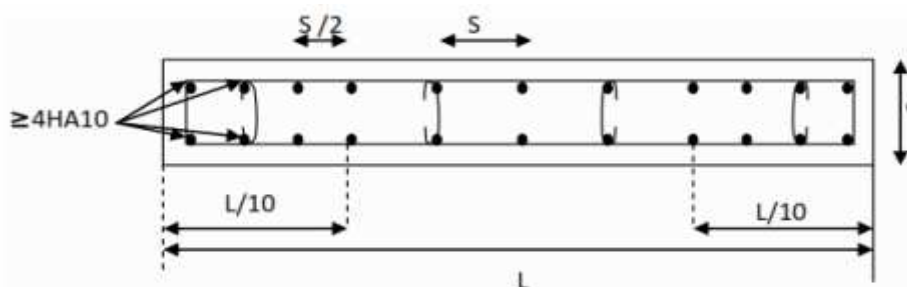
Disposition des armatures verticales dans les voiles.
